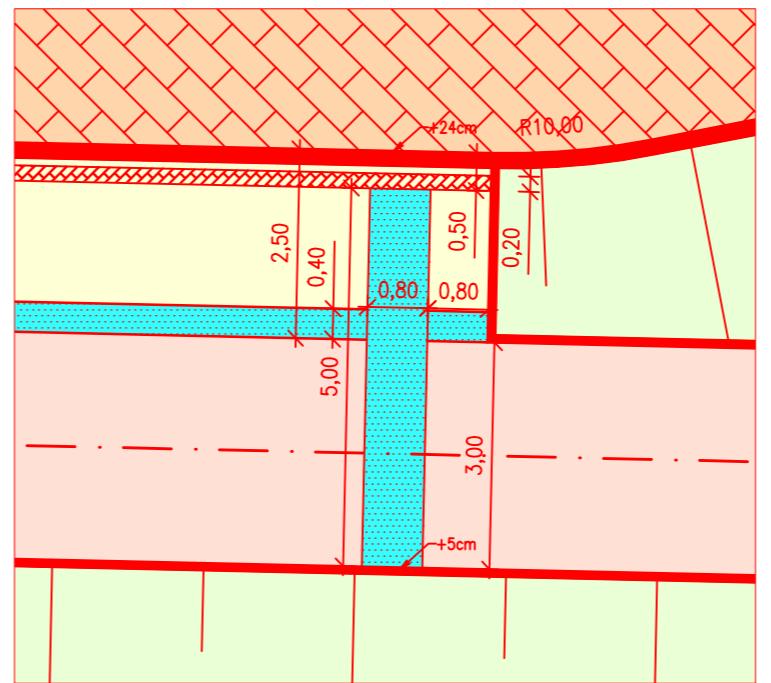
100 (JIŽNÍ VĚTEV)
